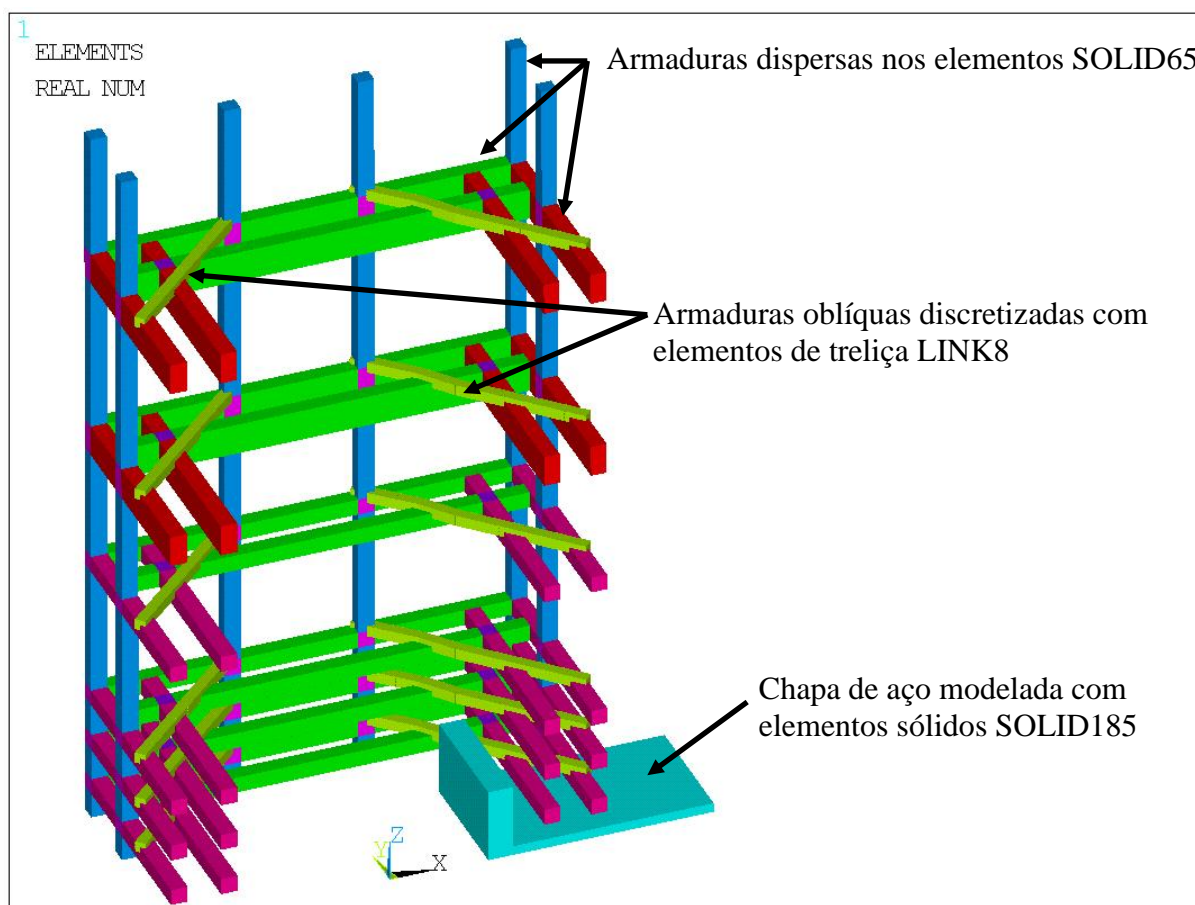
Detalhe da modelagem das armaduras e das chapas (representação de $\frac{1}{4}$ da geometria)
